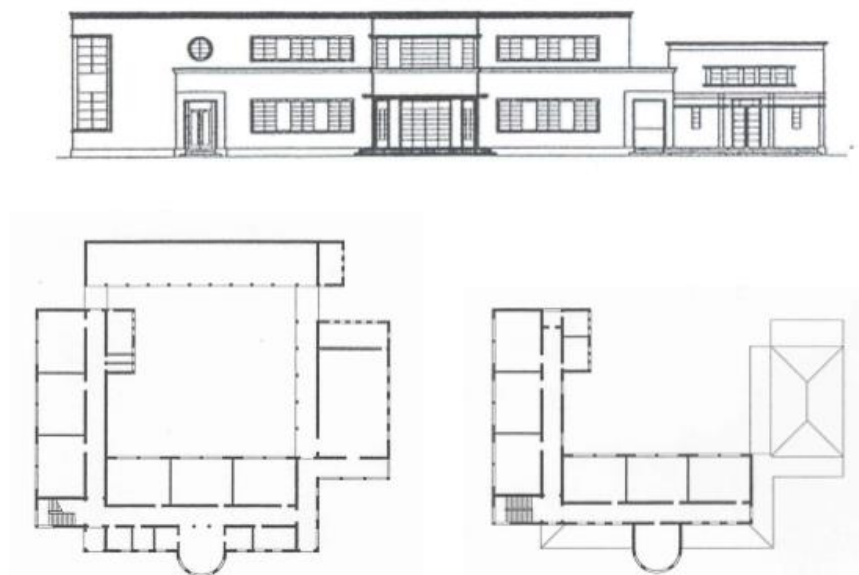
Fachada principal e plantas do 1º e 2º pavimento da Escola Gomes Cardim (1937), SP.
